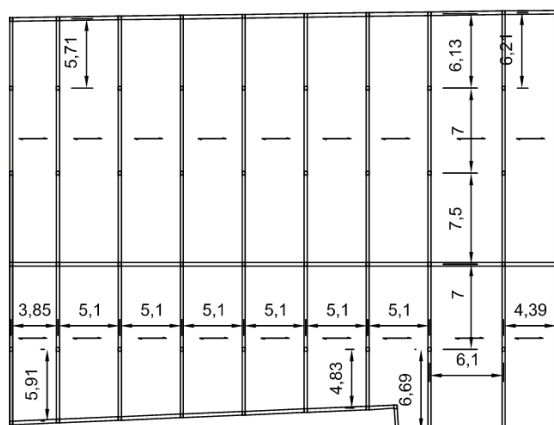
Planta estrutural do primeiro modelo, restantes níveis
